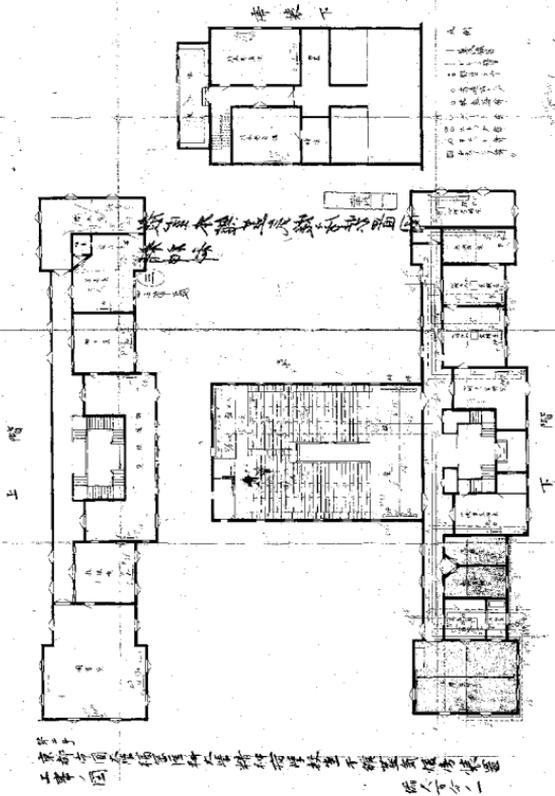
精神病学教室 一階平面図(右下段)・二階平面図(左下段)・裏装束図(上段)
